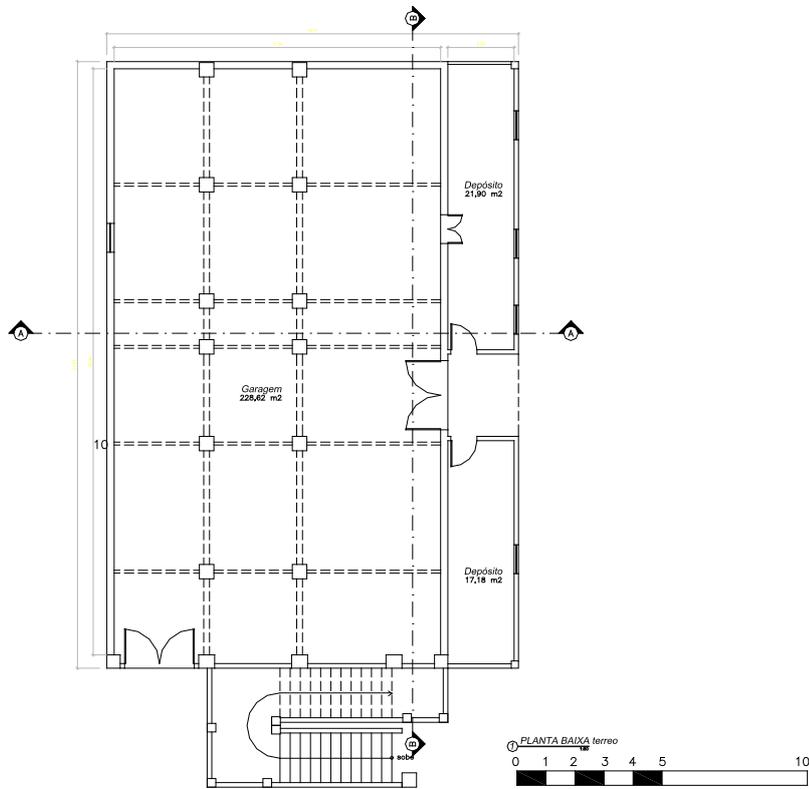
Planta pavimento térreo - porão - Casa do Ozorinho
